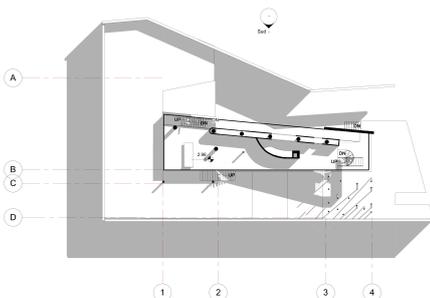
Pilares en diagonal, Villa dall'Ava
